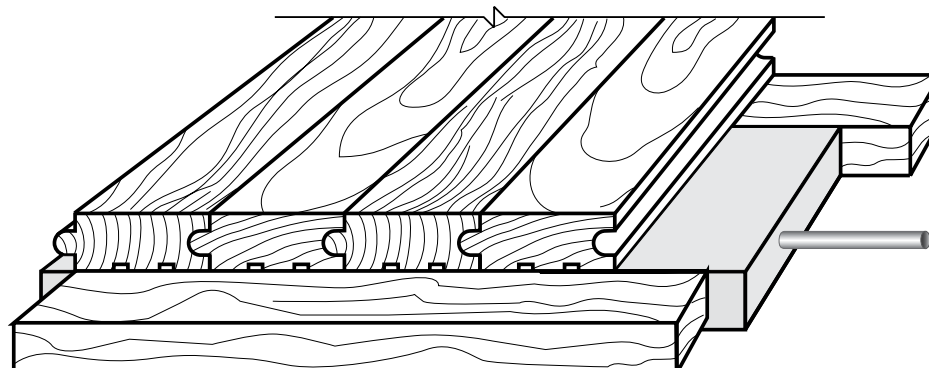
Plancher en bois cloué sur des traverses dans un plancher coulé
